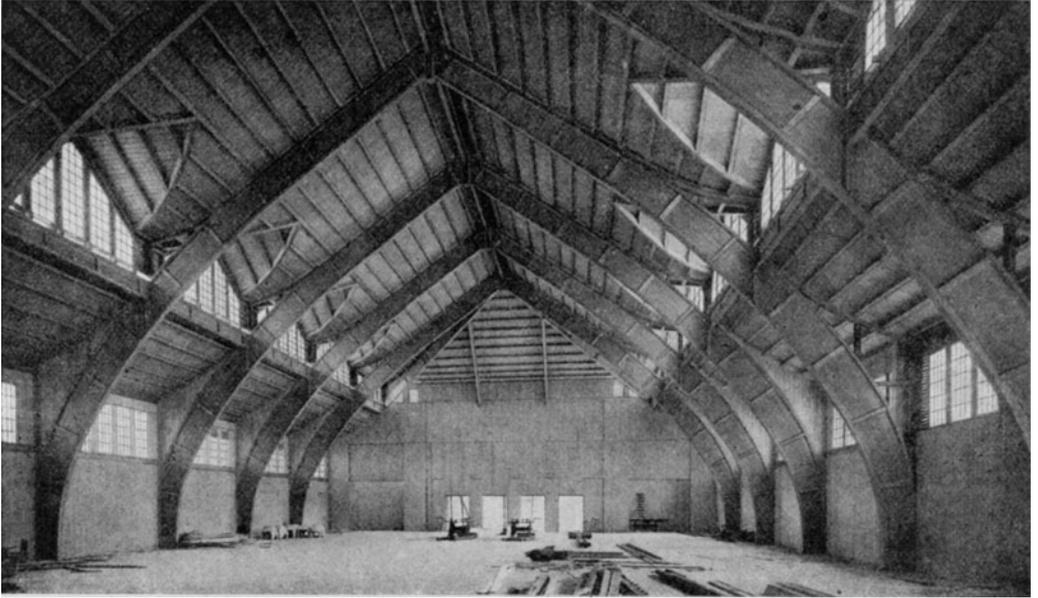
Sporthalle in Leipzig (Iba, 1913); jetzt Provianthalle in Wilhelmshaven.
